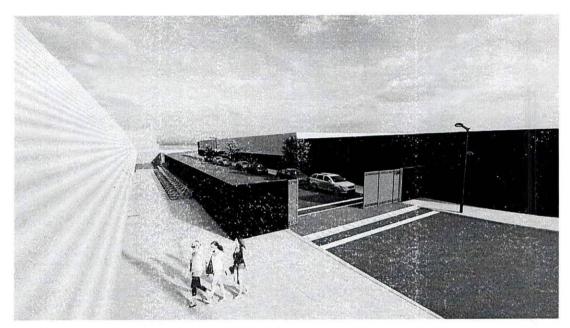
Rampa, Muro e portão proposto na intervenção. Imagem 3D
